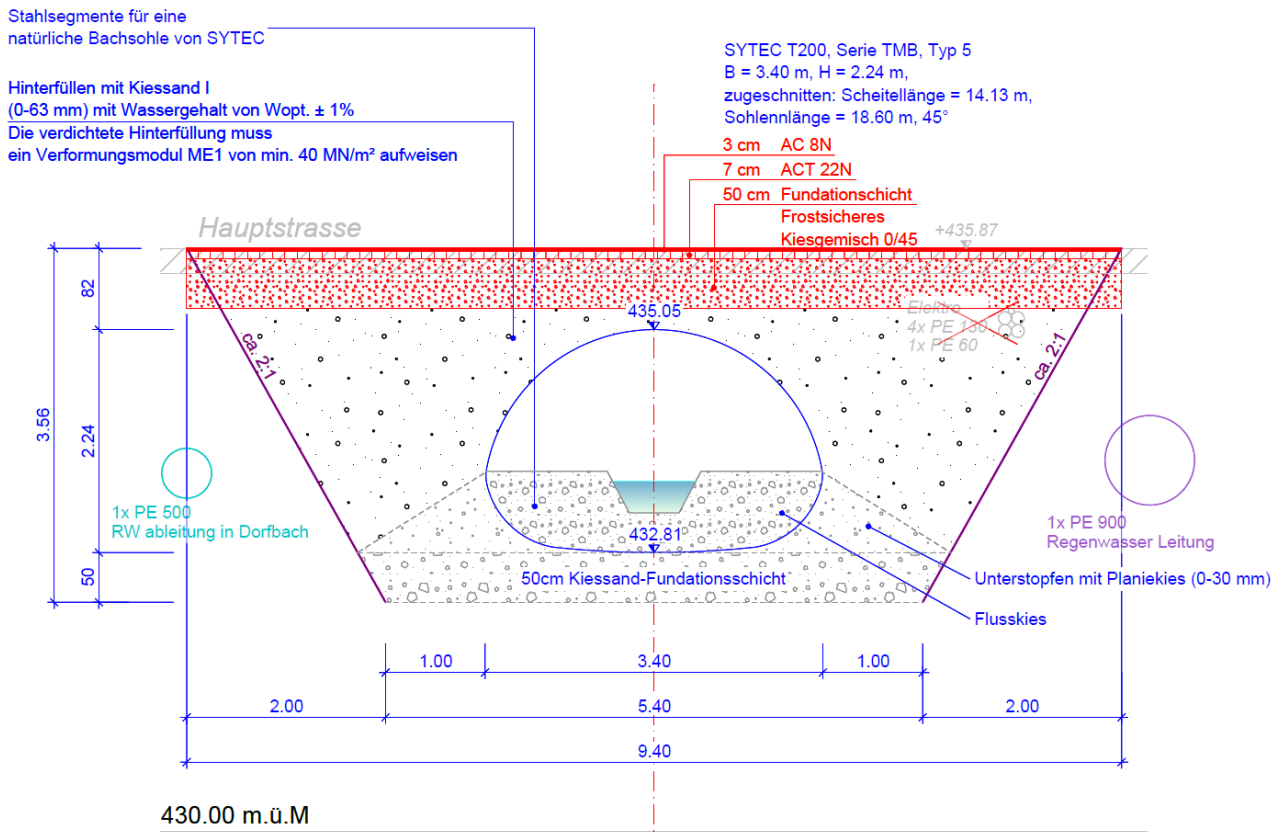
Schnitt B-B Durchlass (Detailplan Durchlass Hauptstrasse, Plan-Nr. 6.285/33.541 A, Beilage 2.9, Stand 21.10.2016).
